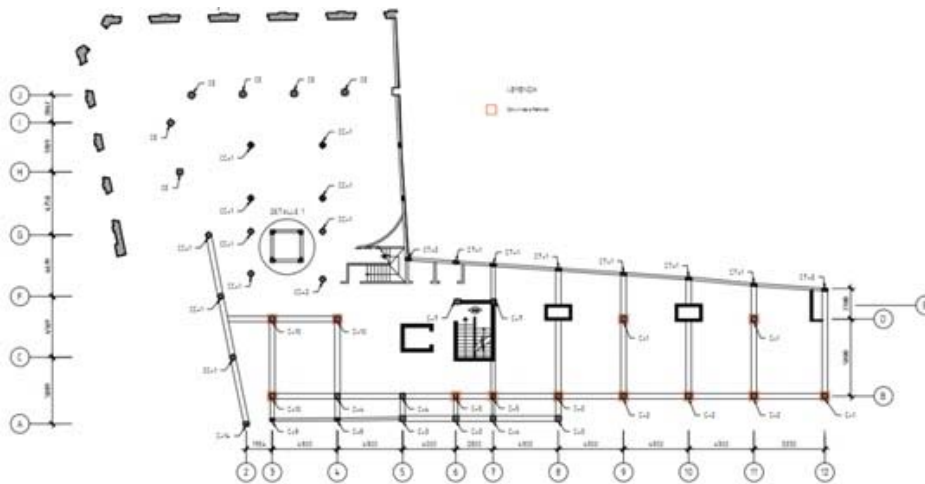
Ubicación de las columnas con necesidad de refuerzo. Fuente: Ramírez y Alfonso (2016).
